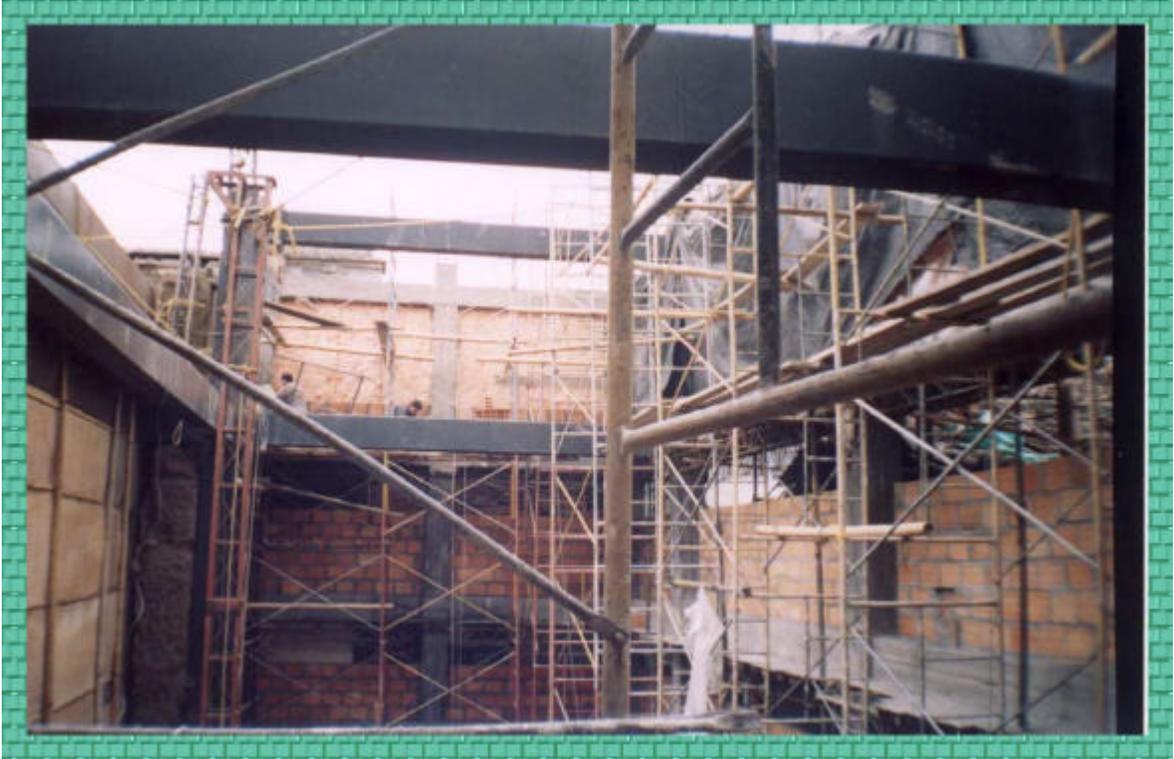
Colocación fresca en los muros sencillos de los pórticos No. 5
